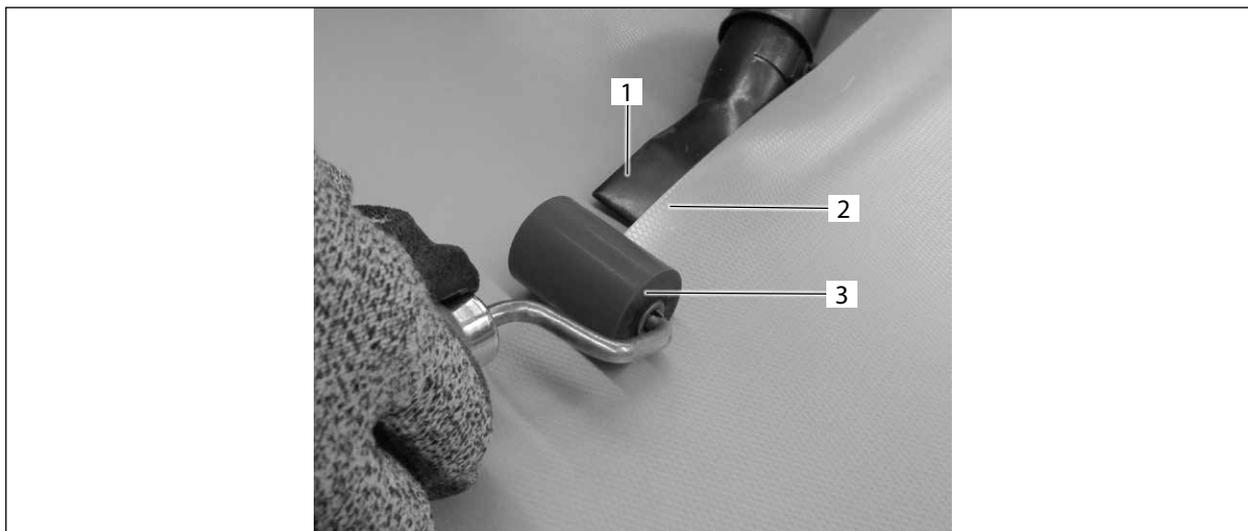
Étanchéité de la membrane de toiture par soudure à l'air chaud
